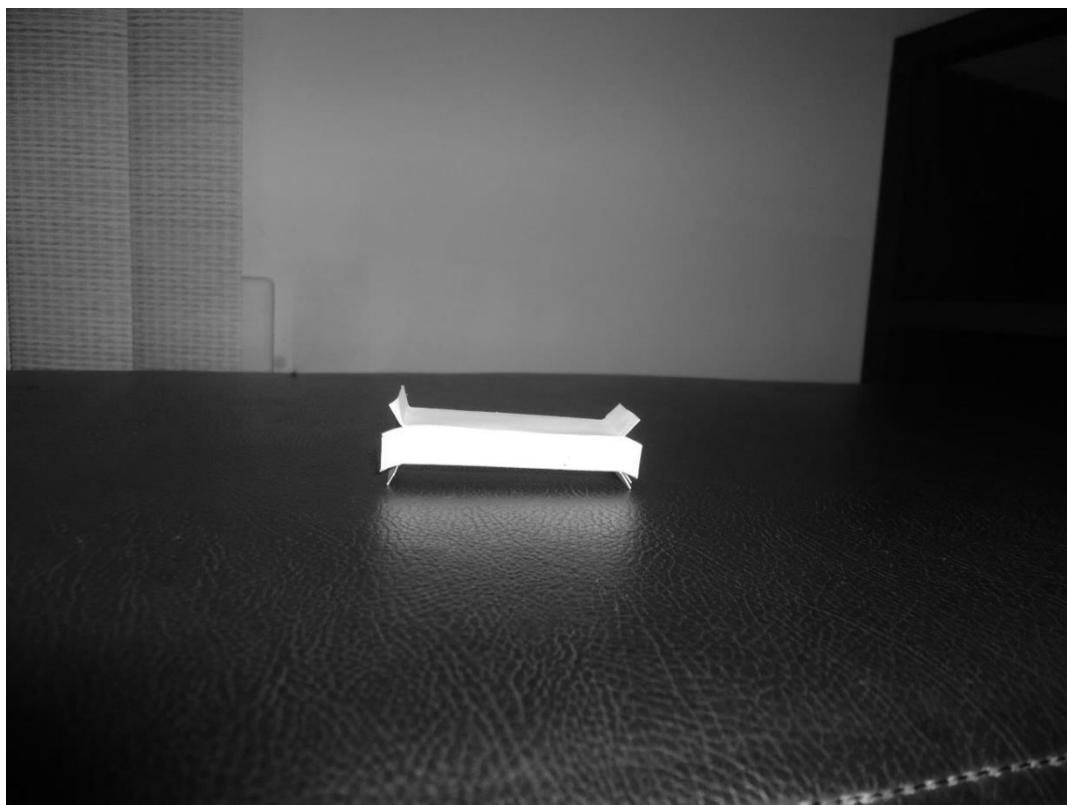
Barra de compressão: 7 cm por 8 cm (vista frontal)
